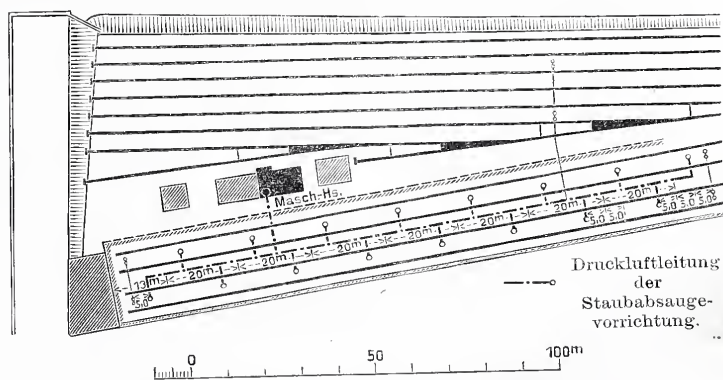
Lageplan der Entstaubungsanlage in Essen.
